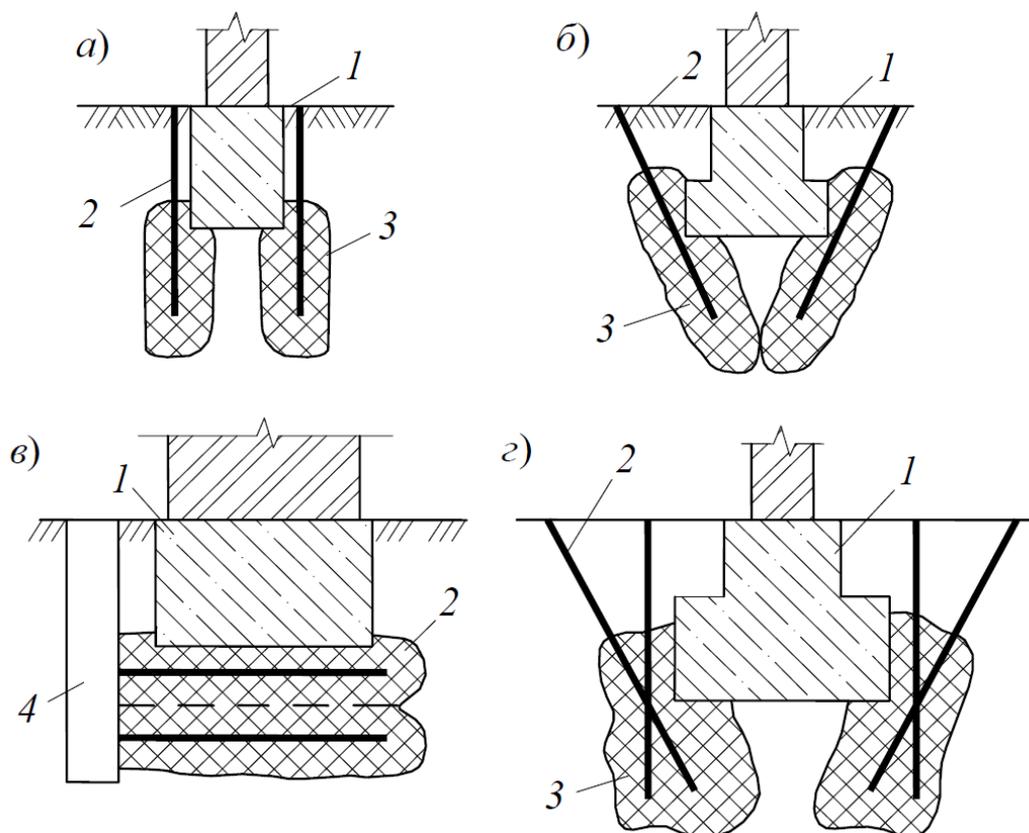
Варианты расположения иньекторов при закреплении грунтов основа ний: 1 – фундамент; 2 – иньектор; 3 – зона закрепления; 4 – шурф
